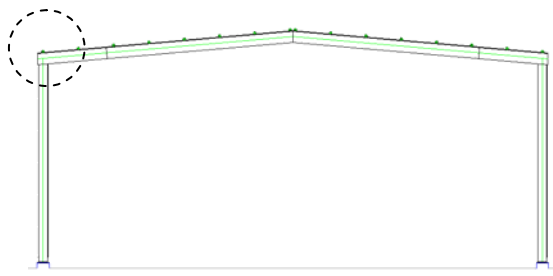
Situació de la barra 30 al pòrtic 4
